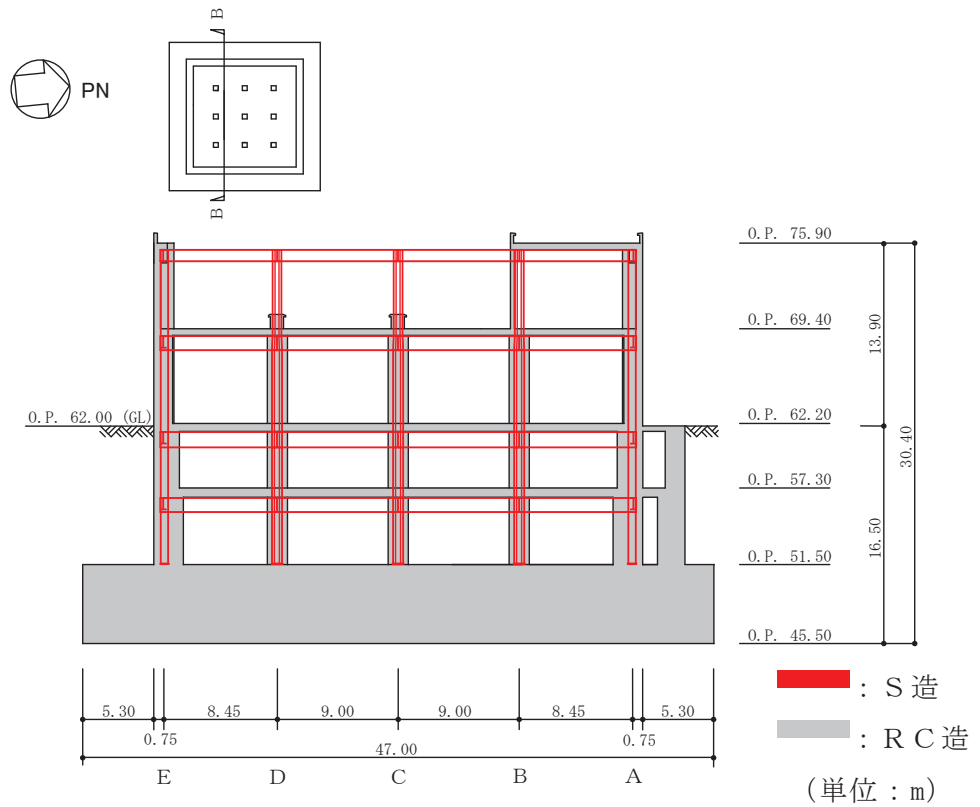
(2) 緊急時対策建屋の概略断面図 (B-B 断面, EW 方向)
